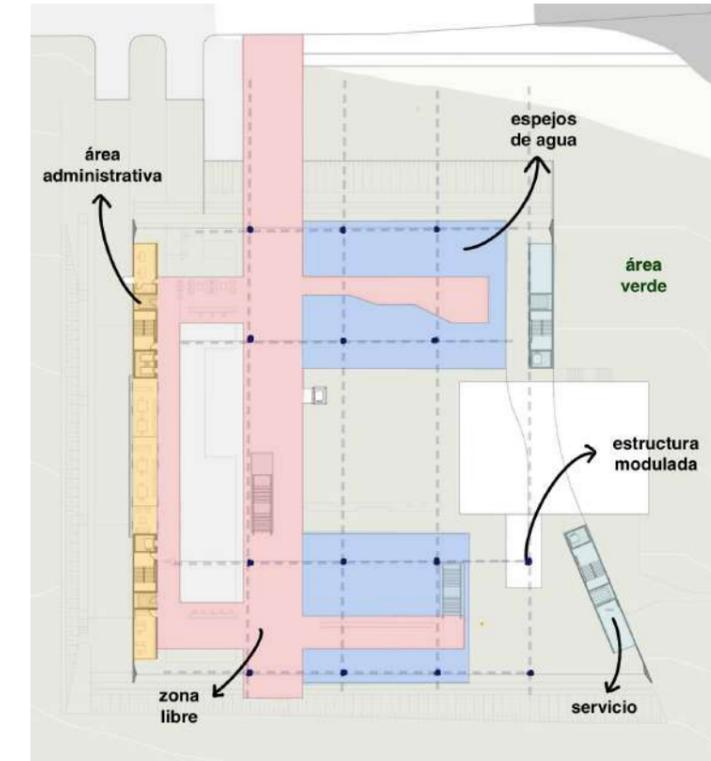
Planta Edificio SEBRAE. Fuente propia.
